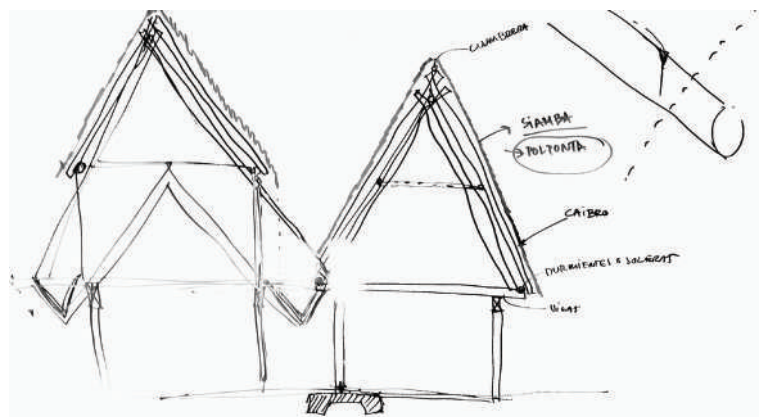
Croquis constructivos en pizarra acrílica durante entrevistas con expertos locales. Elaboración: Equipo proyectista, Lamas 2013.
